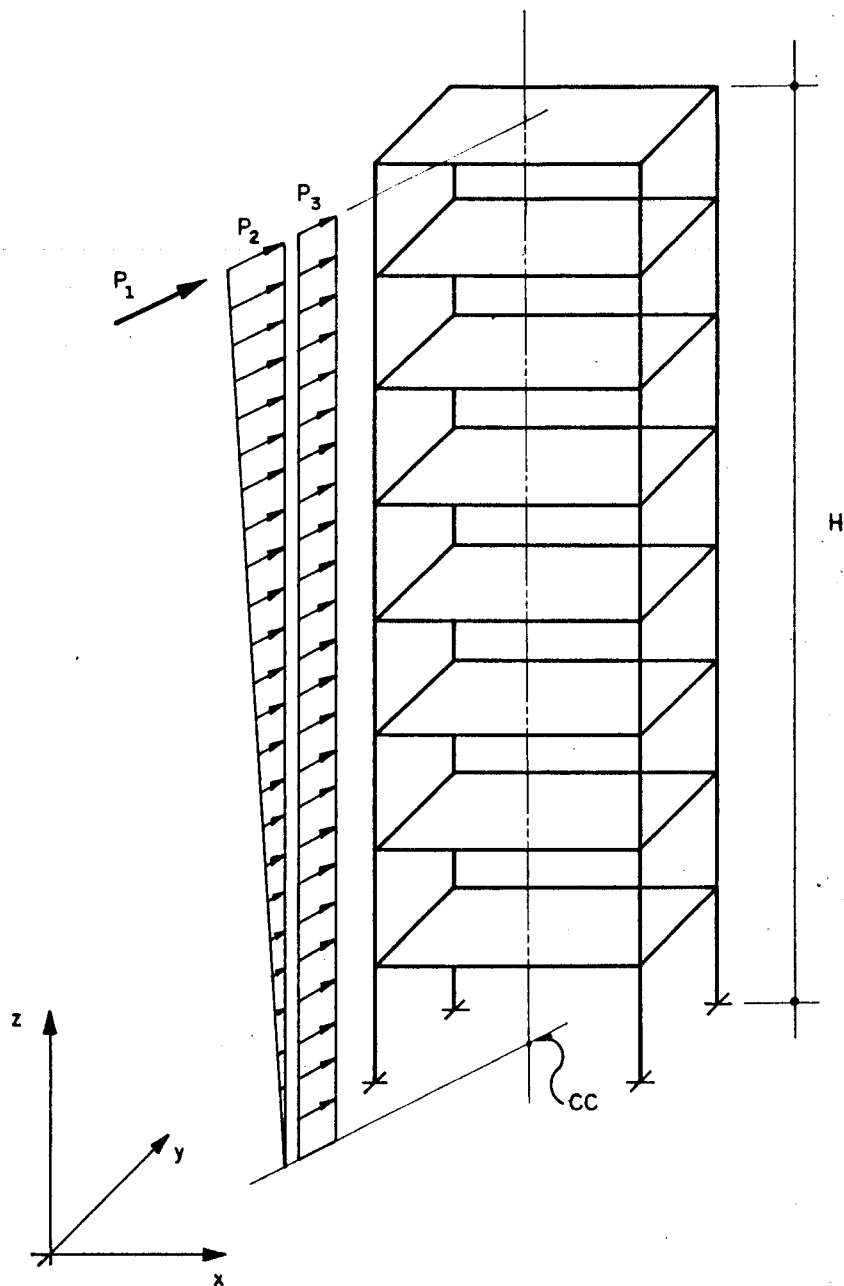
Estrutura tridimensional submetida a um carregamento no centro de carga (CC)
